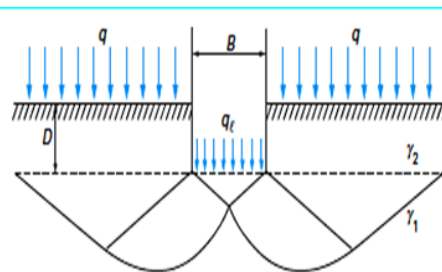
Schéma de rupture d'une fondation superficielle
